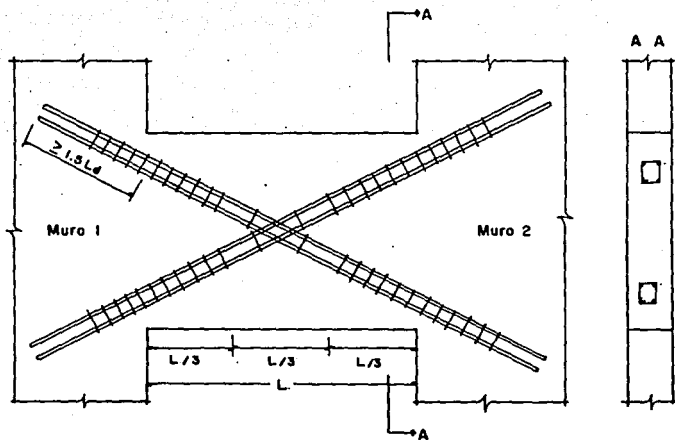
Refuerzo principal de viga diafragma que une muros de corte (Ref.17)
